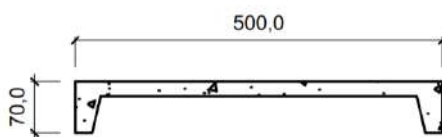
Perfil “U” da chapa em bioconcreto.
